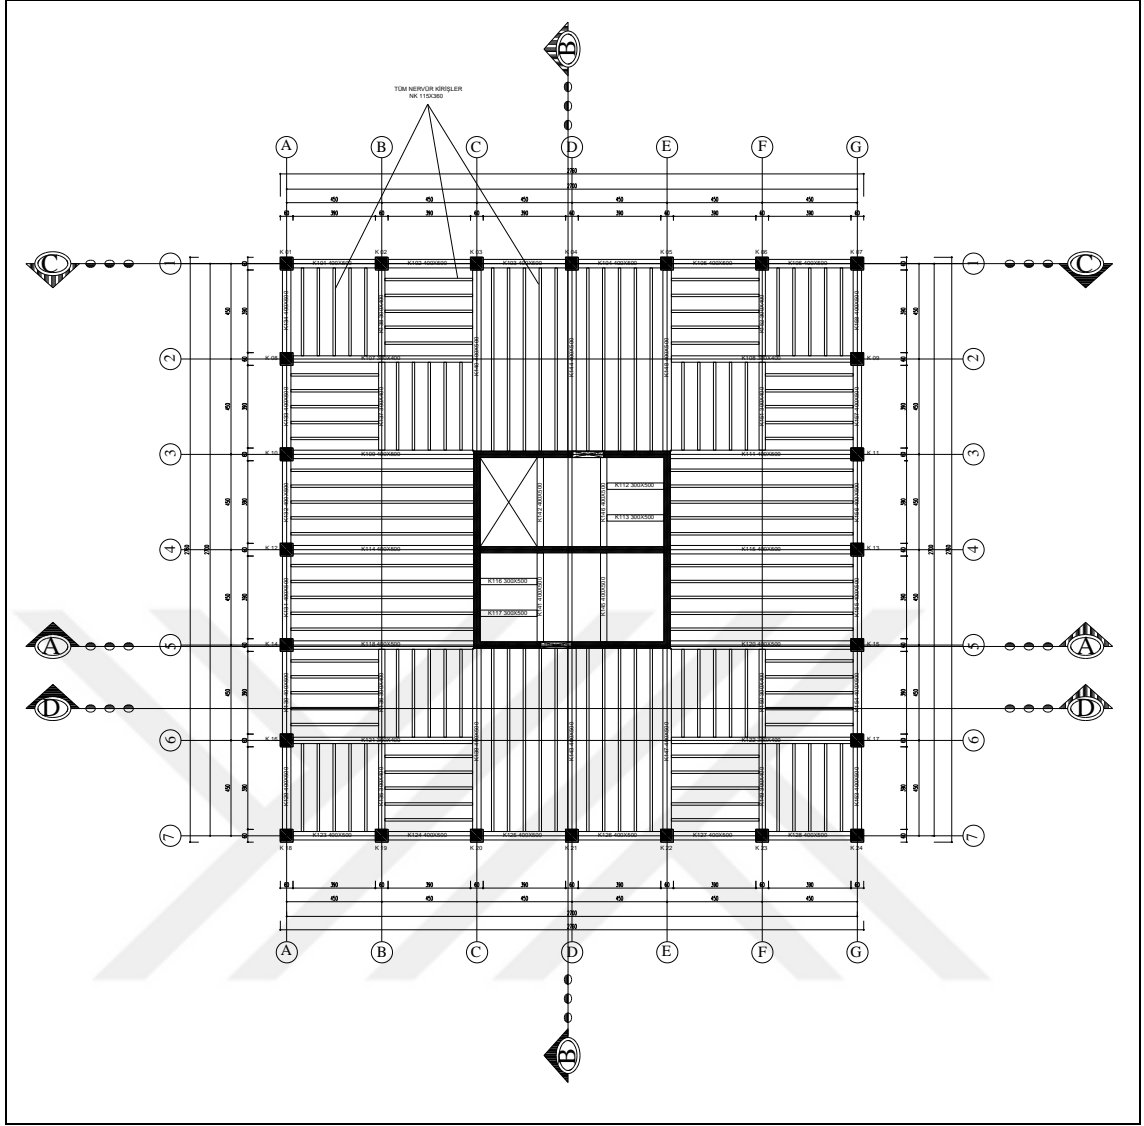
1 Çalışmada kullanılan yapıya ait mimari proje ofis kat planı
